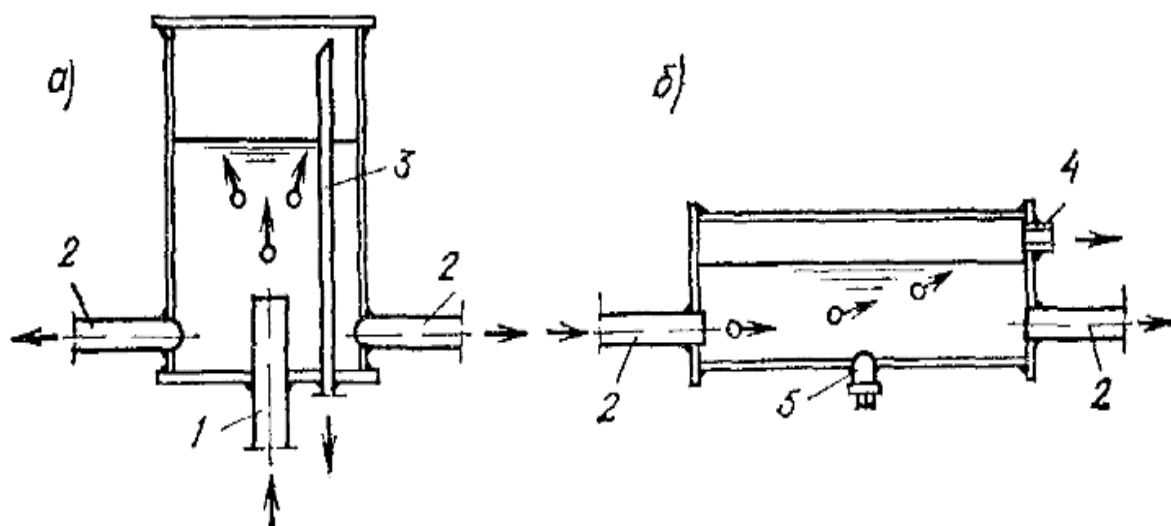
Проточные воздухоборники: а – вертикальный на главном стояке, б – горизонтальный на магистрали; 1 – главный стояк, 2 – магистрали; 3 – труба Ду15 (с краном) для выпуска воздуха; 4 – муфта для воздуховыпускной трубы, 5 – муфта с пробкой для выпуска грязи
